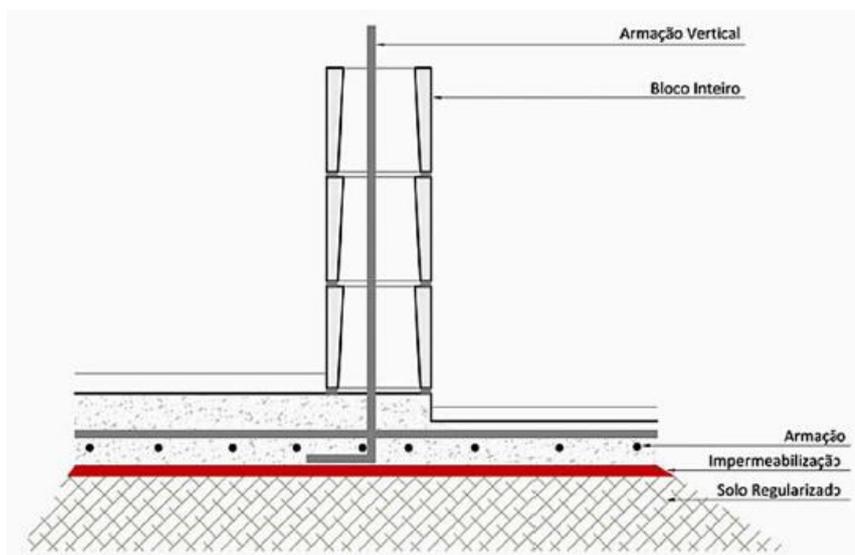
Fixação da espera da armadura vertical em bloco de fundação/viga baldrame, sapata e radier
